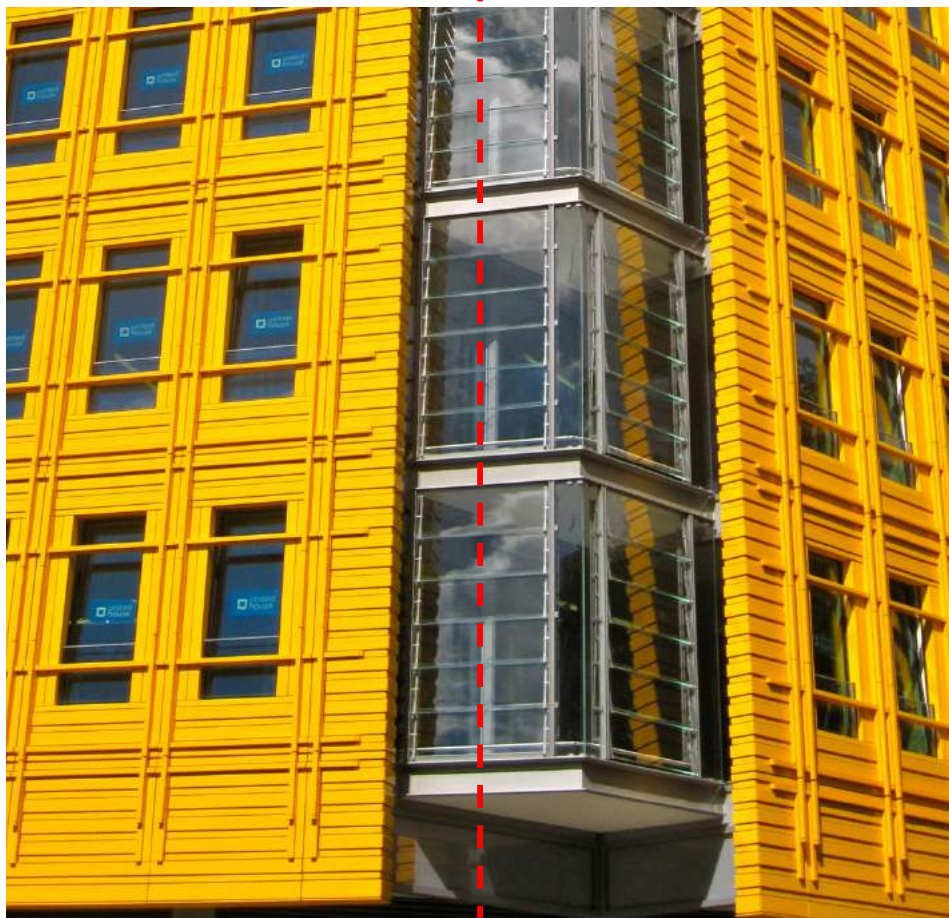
Vista delle serre d'angolo, con individuazione della sezione di dettaglio richiesta
